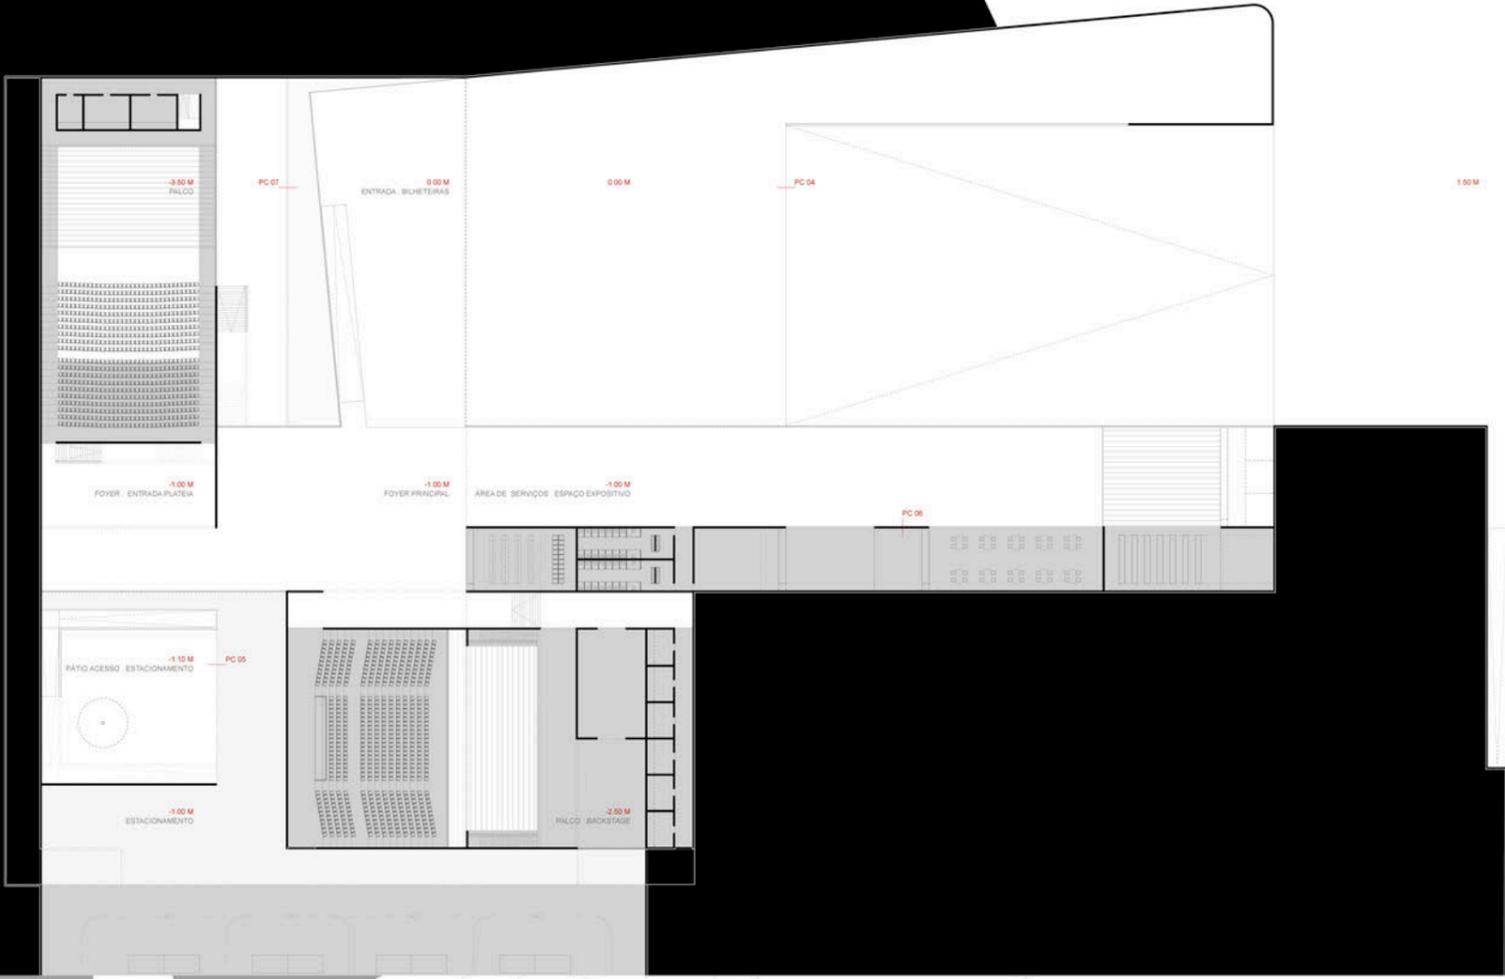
PLANTA PISO 0 / PLANTA PISO 1 . EQUIPAMENTO CULTURAL
